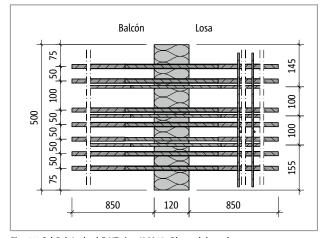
Schöck Isokorb® XT tipo K-M12: Plano del producto
